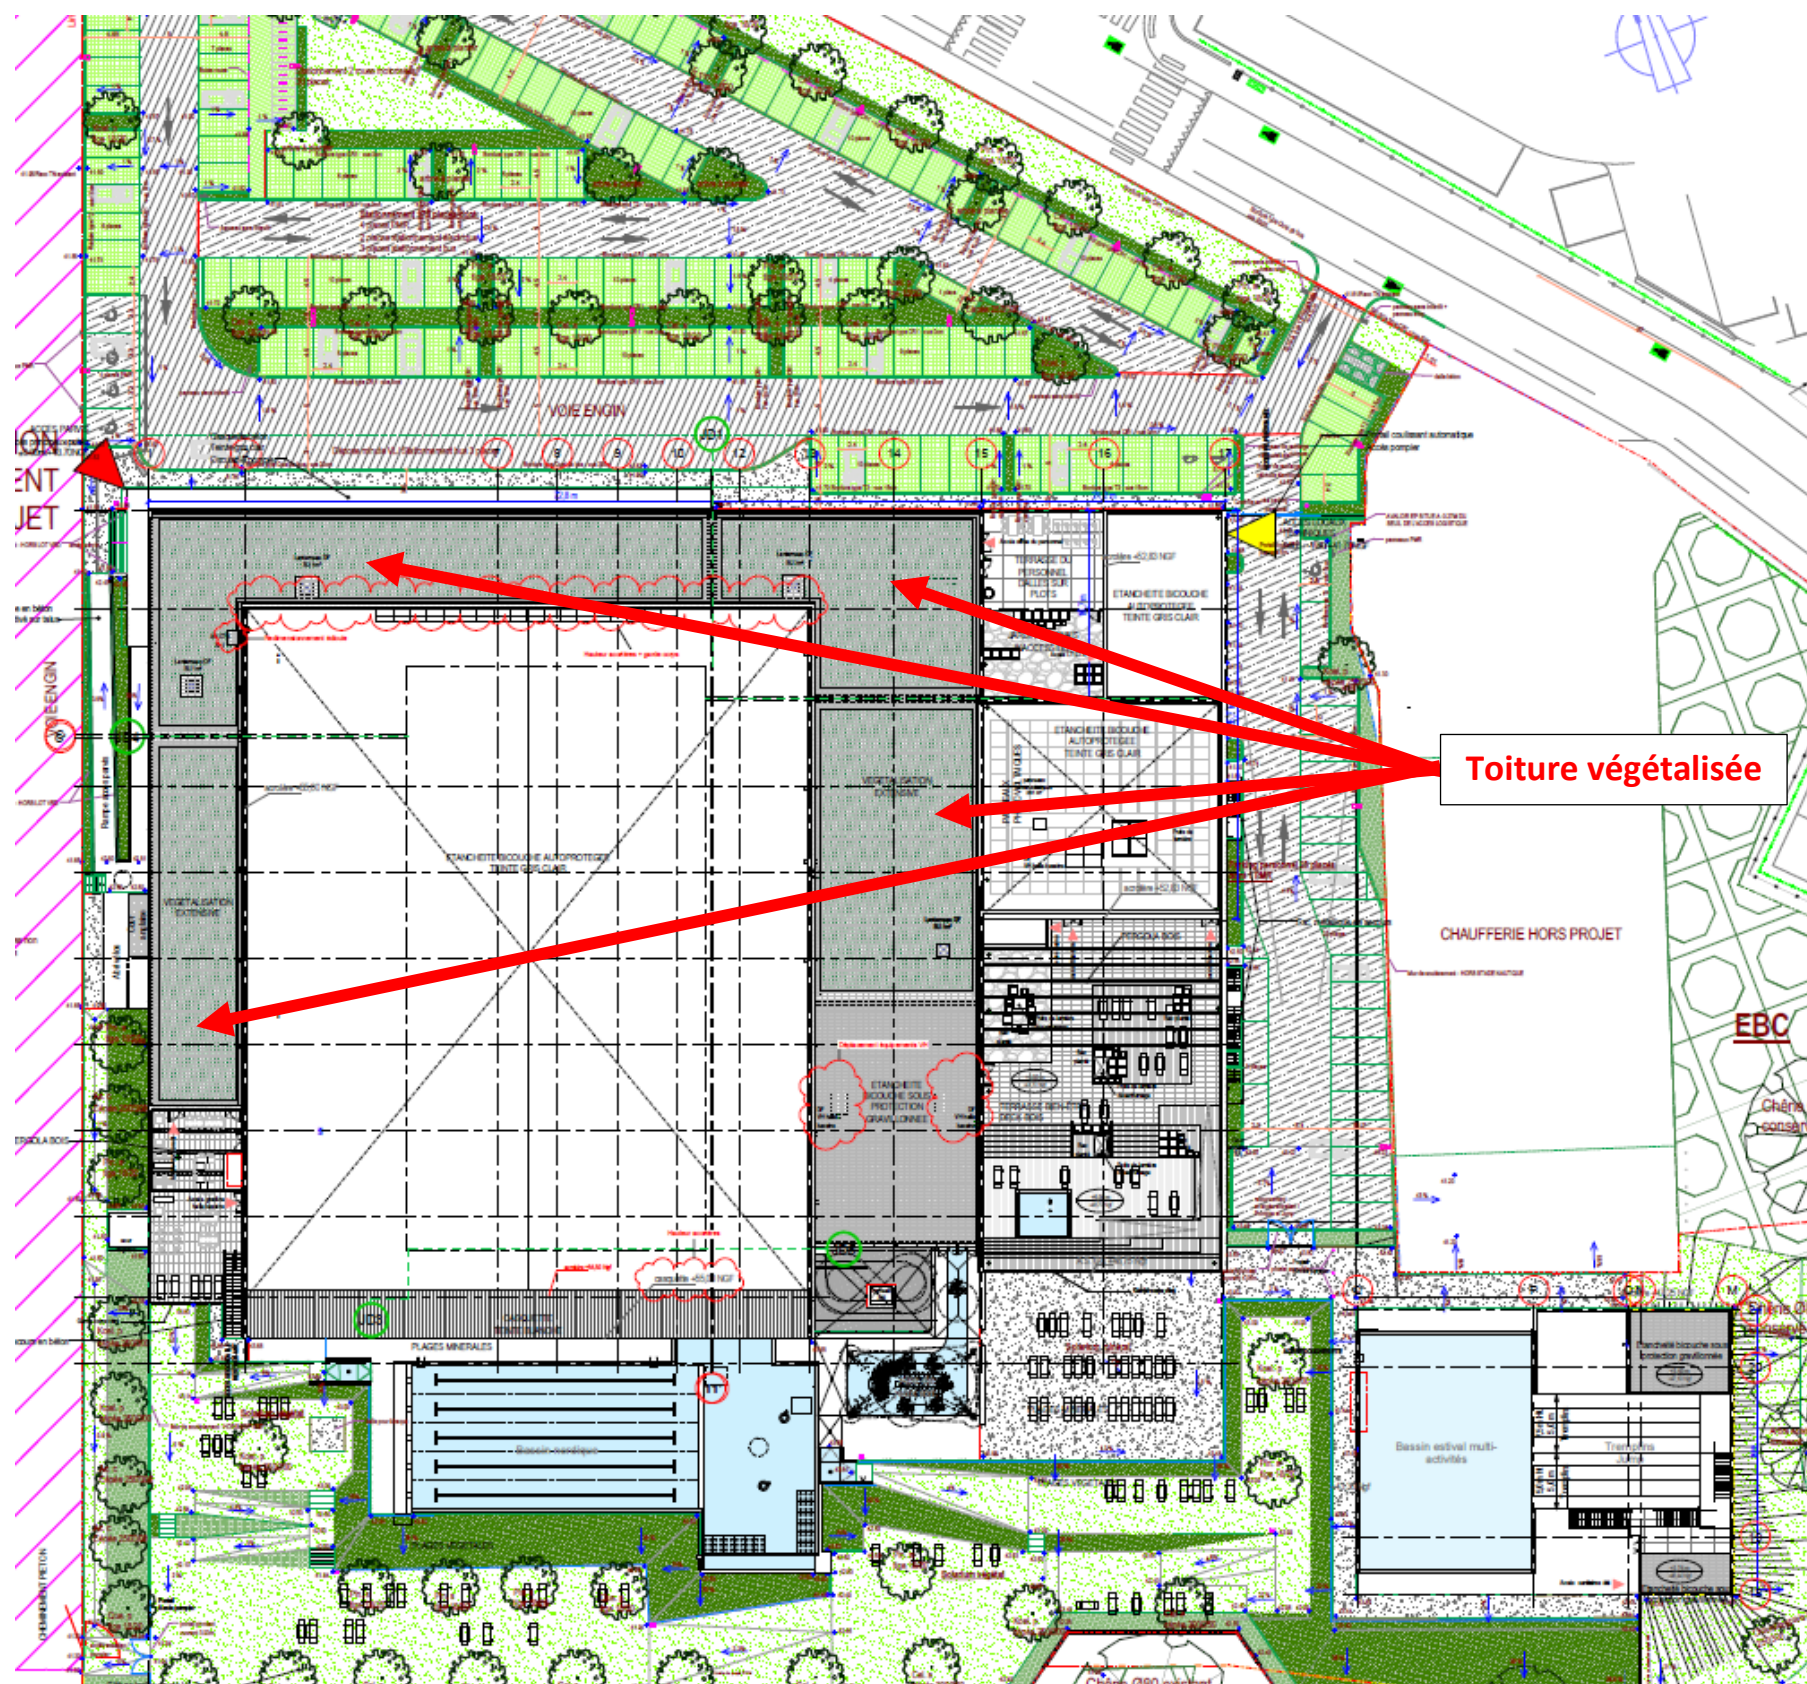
Toiture végétalisée. Source : PCM2, Plan de toitures
